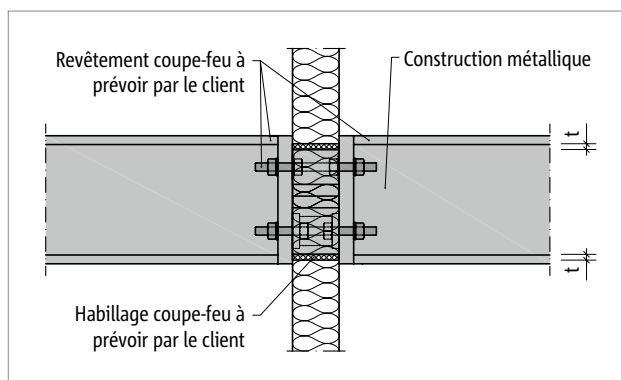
Protection incendie Schöck Isokorb® T type S : Bardage de protection incendie sur site - T type S, construction en acier avec revêtement de protection incendie ; coupe
